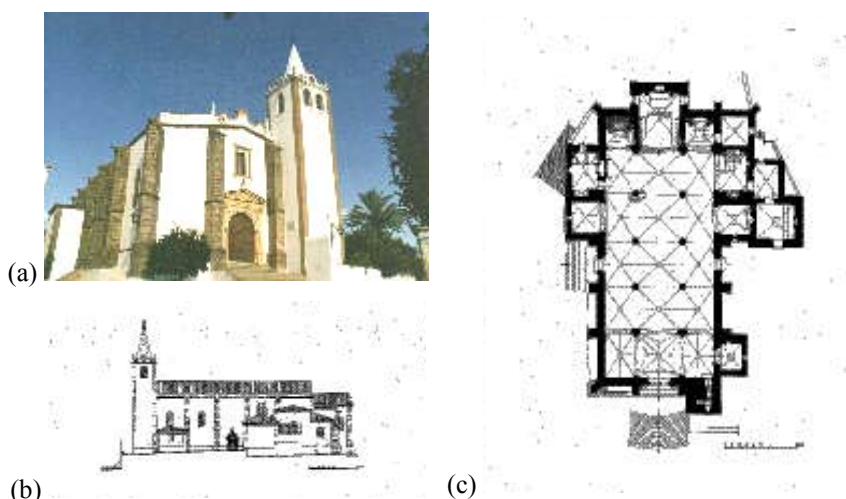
Peças desenhadas [Fonte: DGEMN]: (a) alçado da fachada; (b) corte longitudinal e (c) planta.
